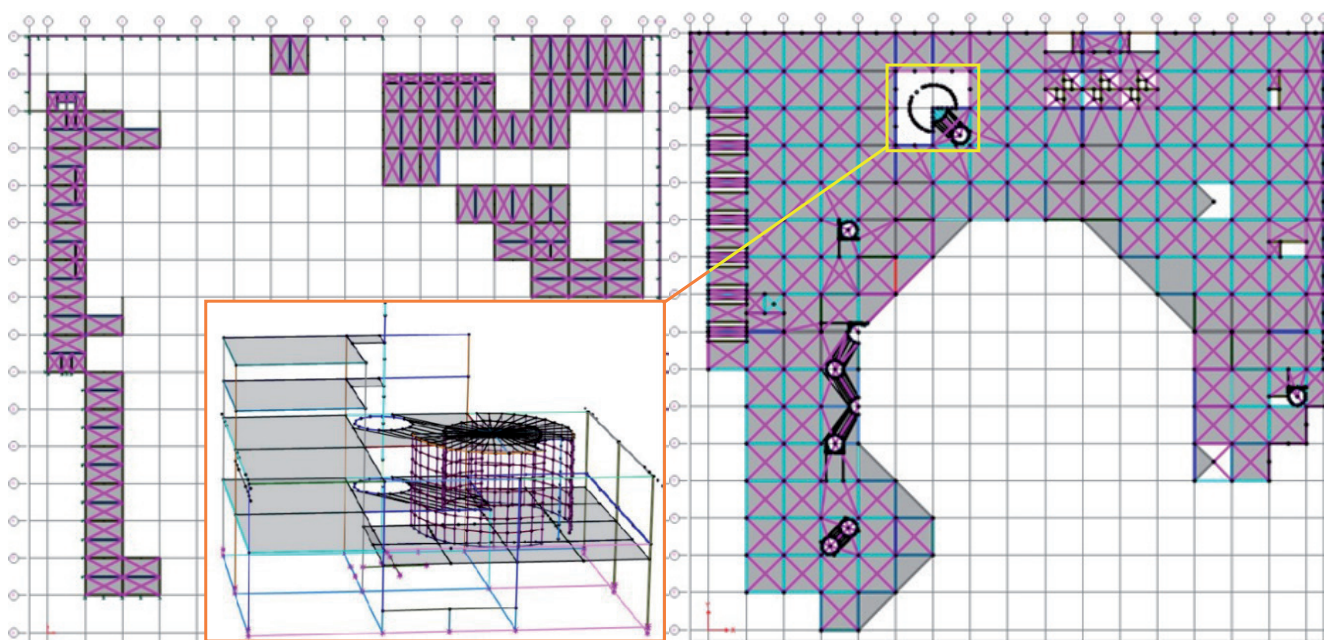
Vista in pianta degli impalcati ai piani mezzanino (sinistra) e terra (destra) con dettaglio di modellazione del corpo chiesa.
